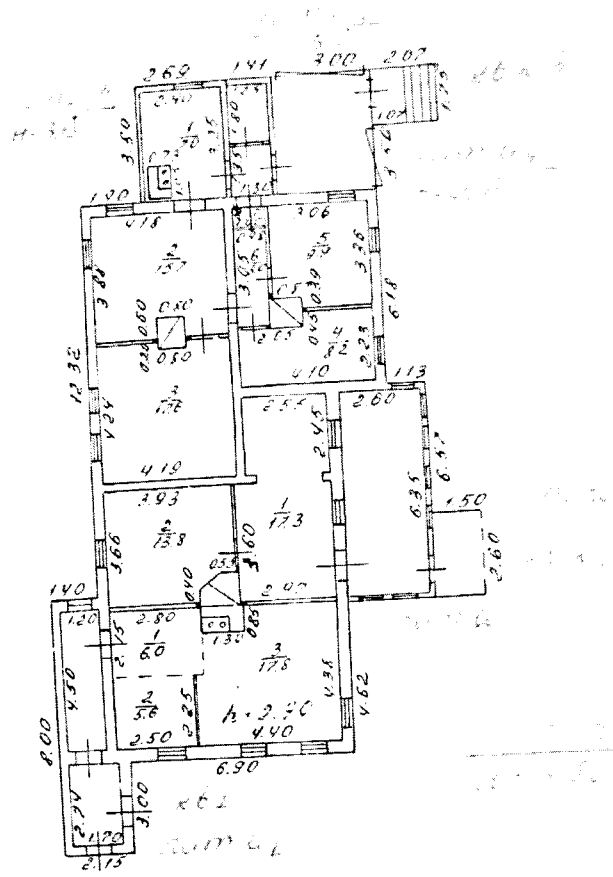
План жилого дома (лит. А). Архив БТИ, 1988 г.
